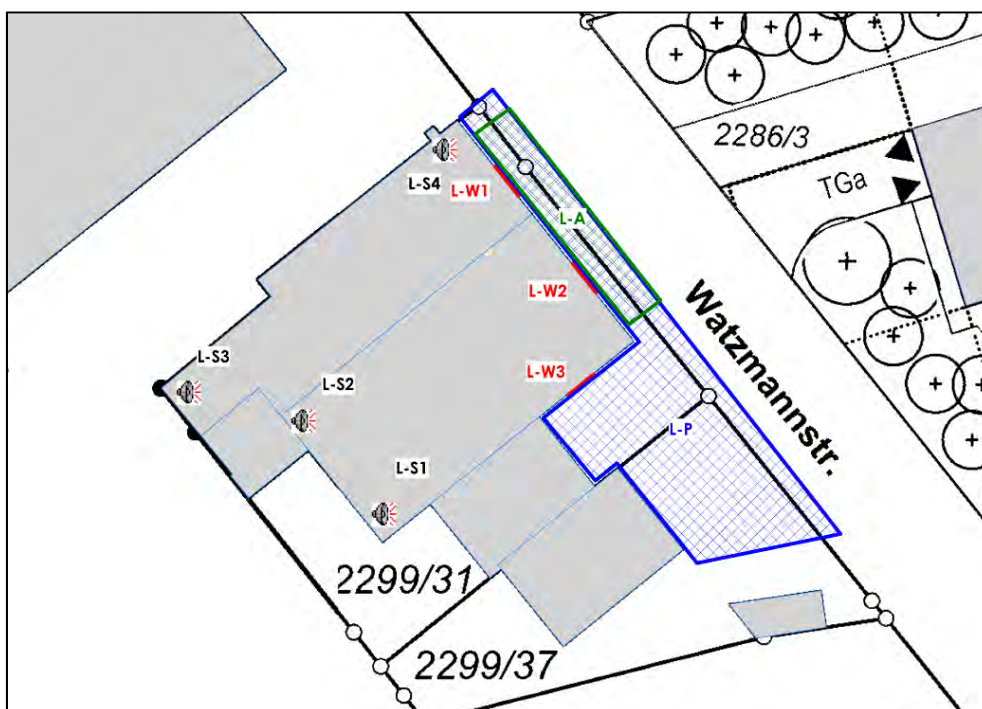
Lageplan mit Darstellung der Schallquellen
